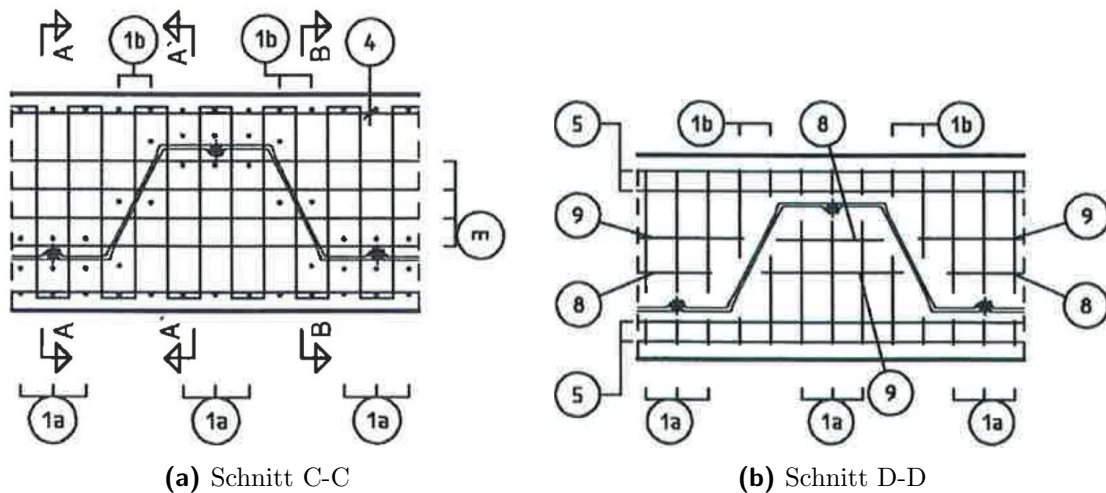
Bewehrungsführung „mit Konsoleinspannung“ [6]
